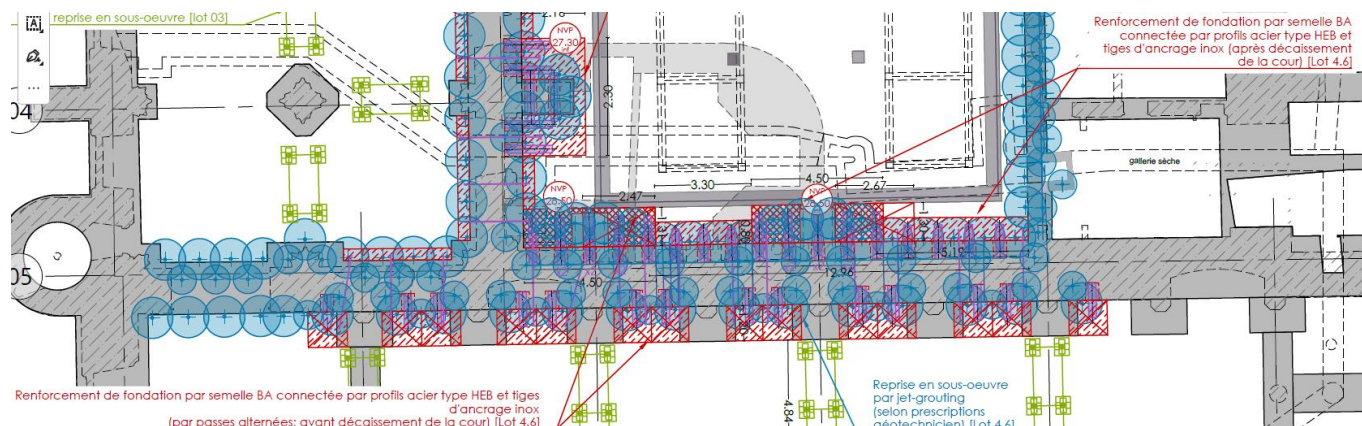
Plan de principe de l'implantation des colonnes de jet grouting au droit de la façade Sud (Conciergerie)
